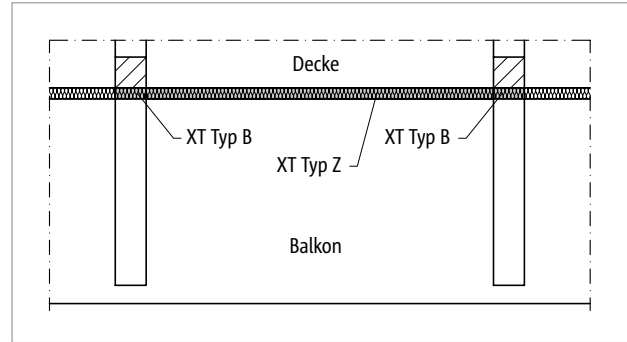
Schöck Isokorb® XT Typ B: Balkonkonstruktion mit frei auskragenden Unterzügen
